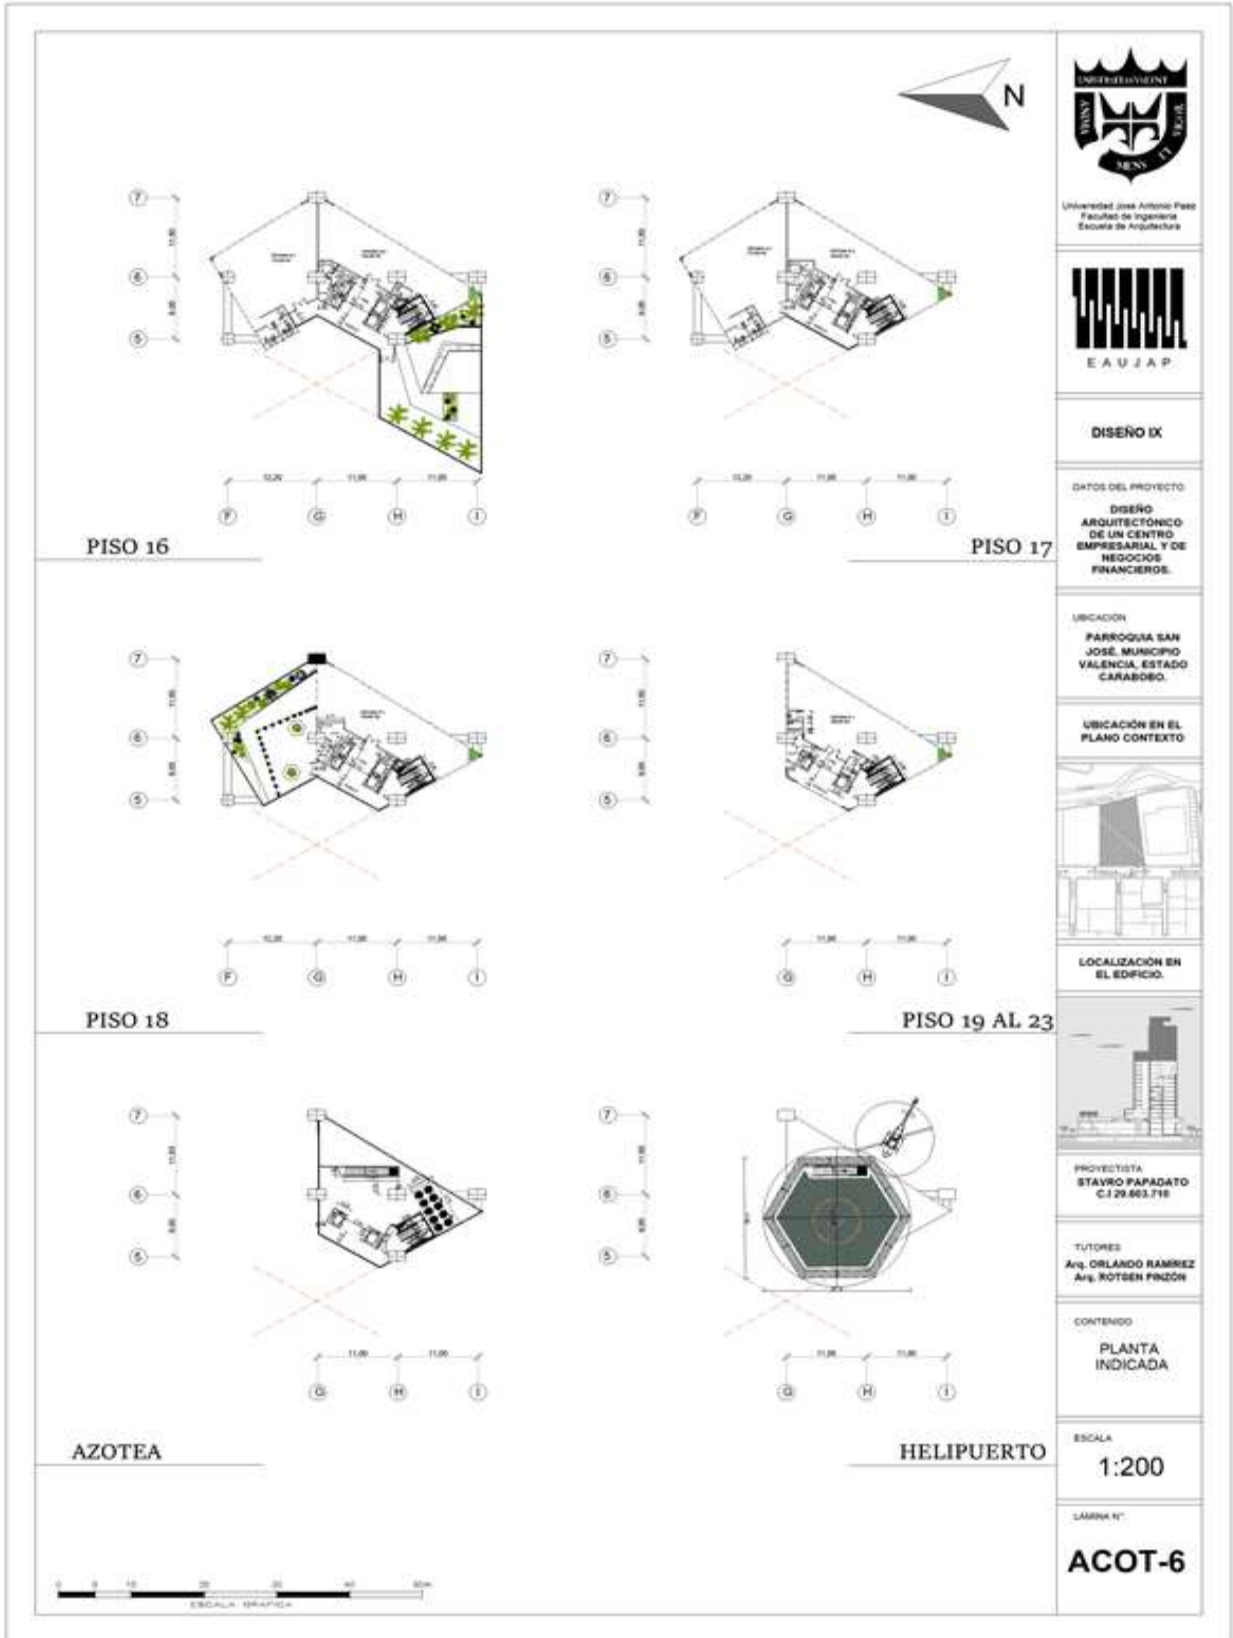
ACOT – 6 Planta Indicada Piso 16 al Helipuerto Fuente: El Autor (2023)
